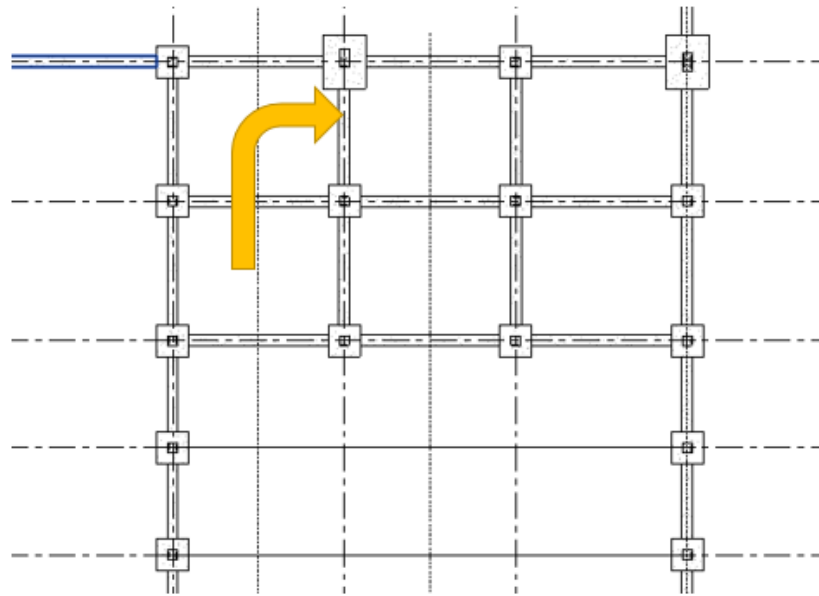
Boceto de la escalera para ascender a la primera plana.
